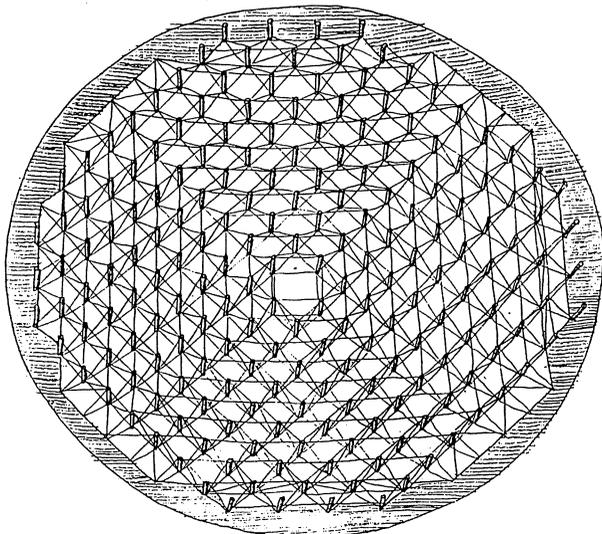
CUBIERTA DEL ESTADIO OLIMPICO DE ATLANTA.
